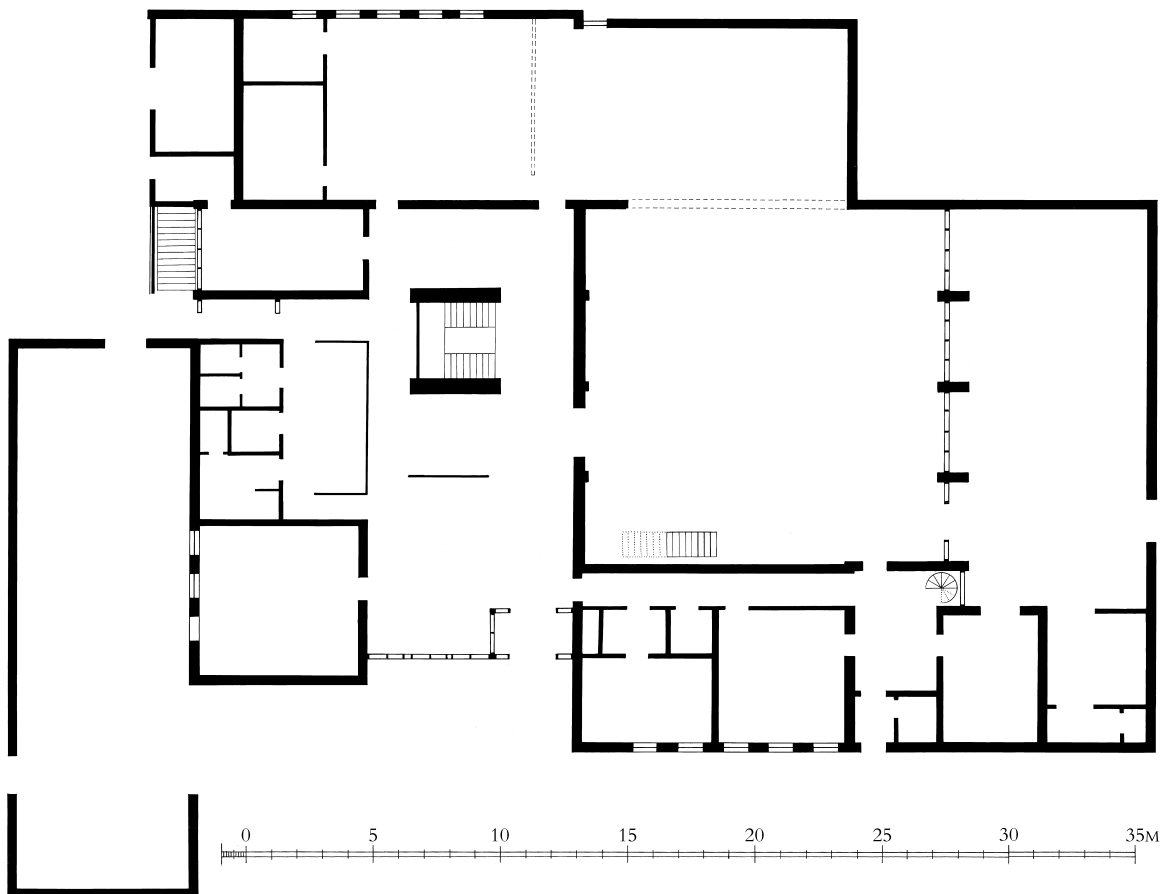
Plan. 1:300. Tegnet af Lars Jensen, suppleret og tegnet af Merete Rude 2014. – *Ground plan.
